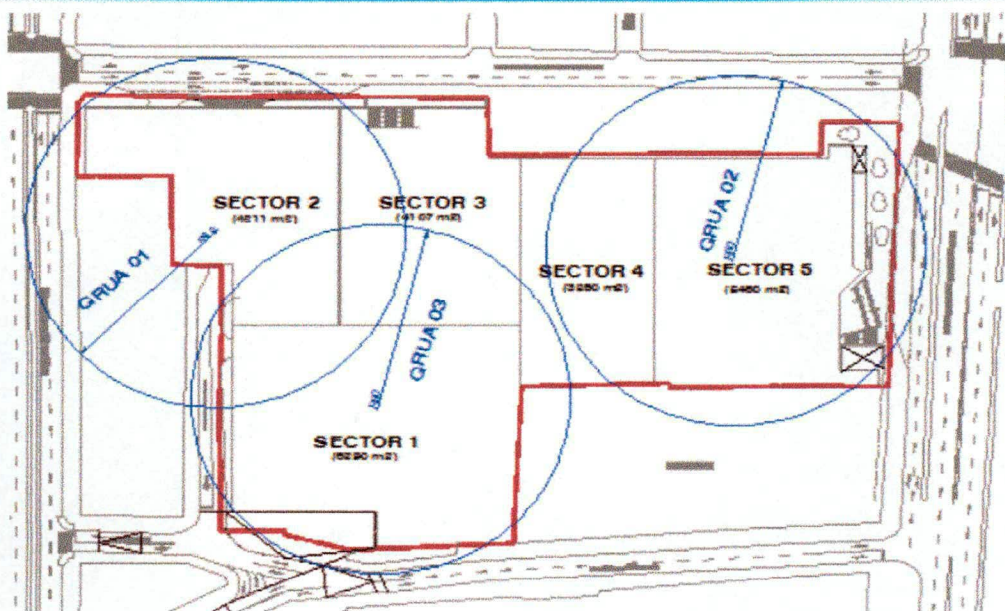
Ubicación de las torres grúa y radio de giro
